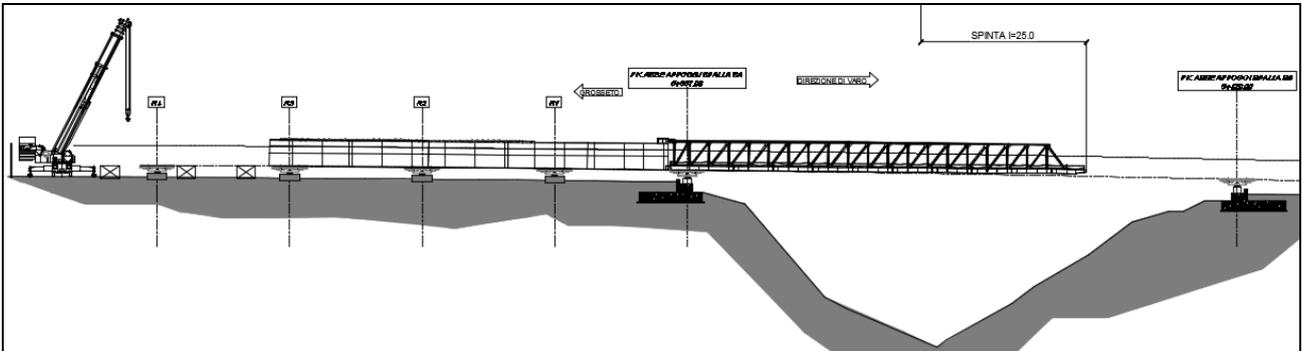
b Viadotto Cerreto - Modalità di varo
